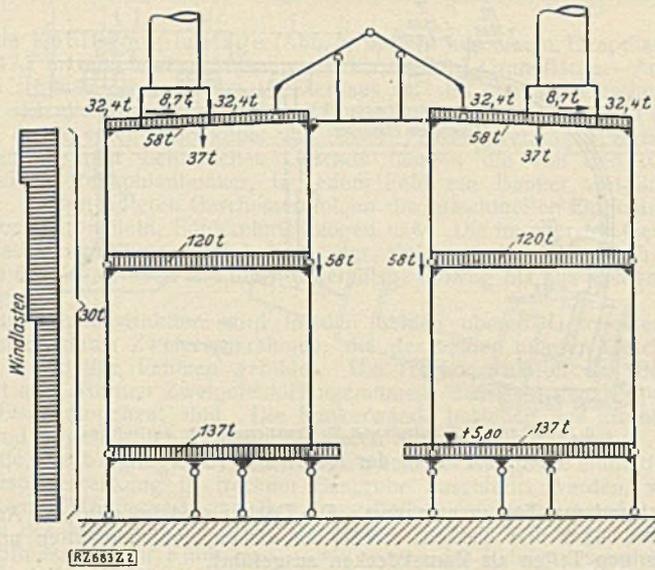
Kesselhausquerschnitt mit Dach-, Bühnen- und Windlasten für einen Binder.
